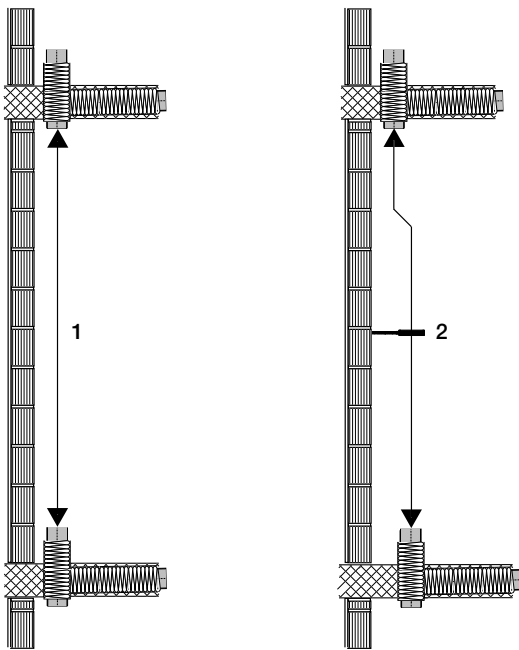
De buislengte L wordt tussen de ingestorte gelijkzijdige T-stukken ingepast
